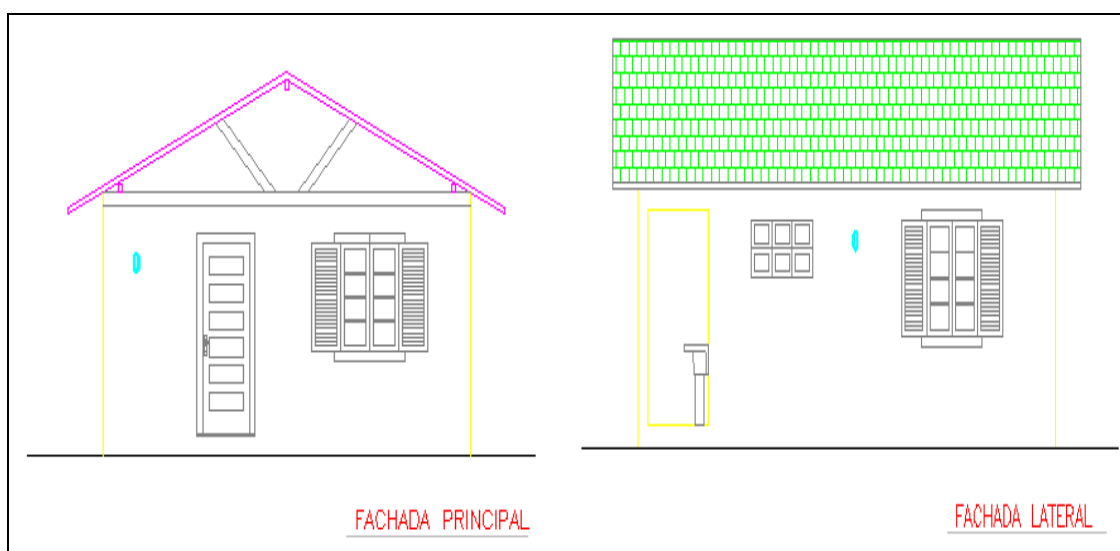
Planta da fachada principal e lateral do modelo padrão da casa popular
